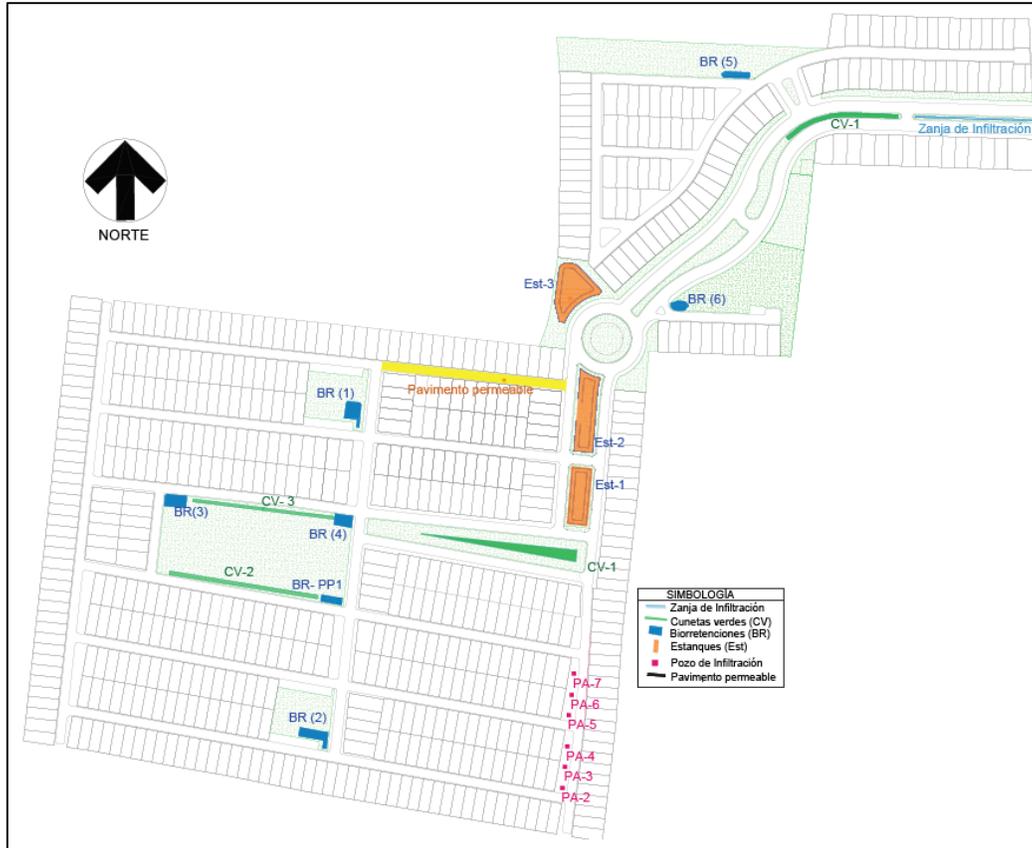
Vista en planta de la ubicación final de los sistemas SUDS.
